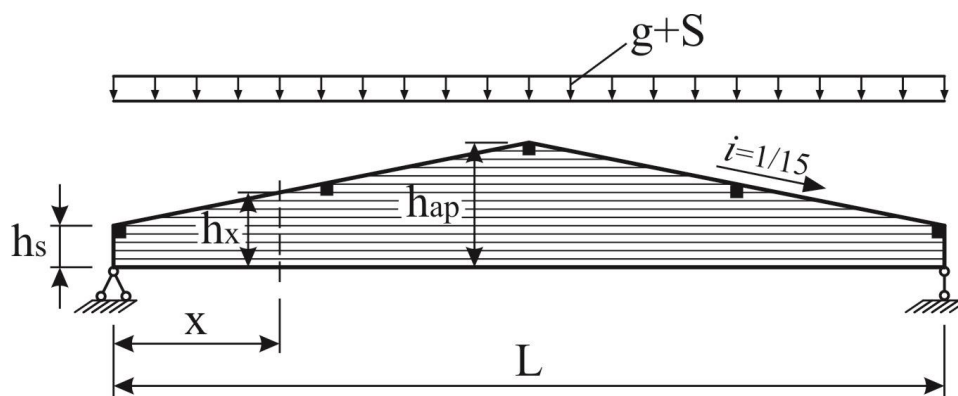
Схема навантаження балки та місця розкріплення верхнього поясу
